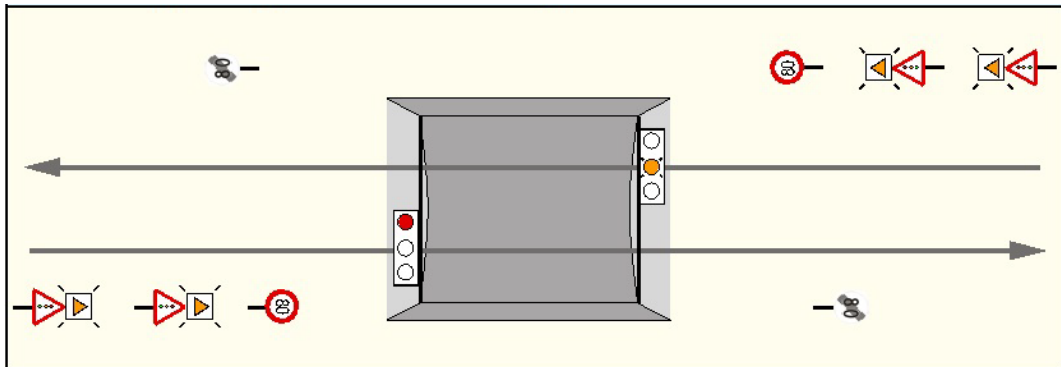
Plan de feux – Fermeture du tunnel dans une direction.
